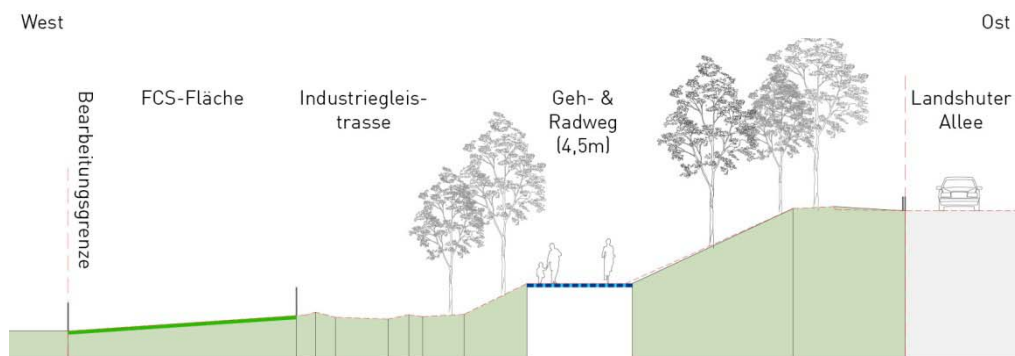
Wegeführung im Bereich der FCS-Fläche (Verkleinerung, Originalmaßstab Schnitt B-B' 1:200)
